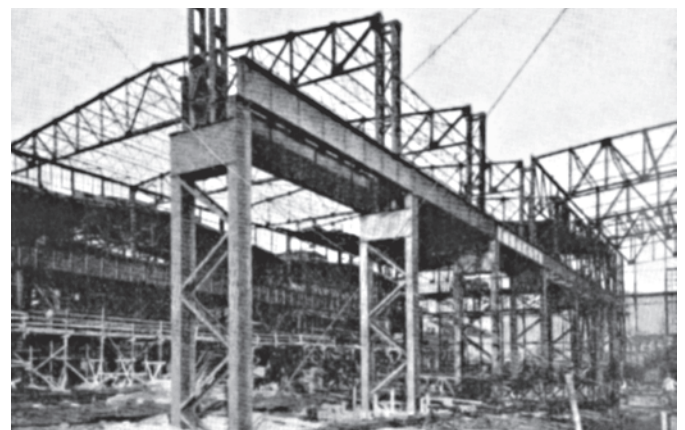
Halle mit Fachwerkstützen [1.18]
